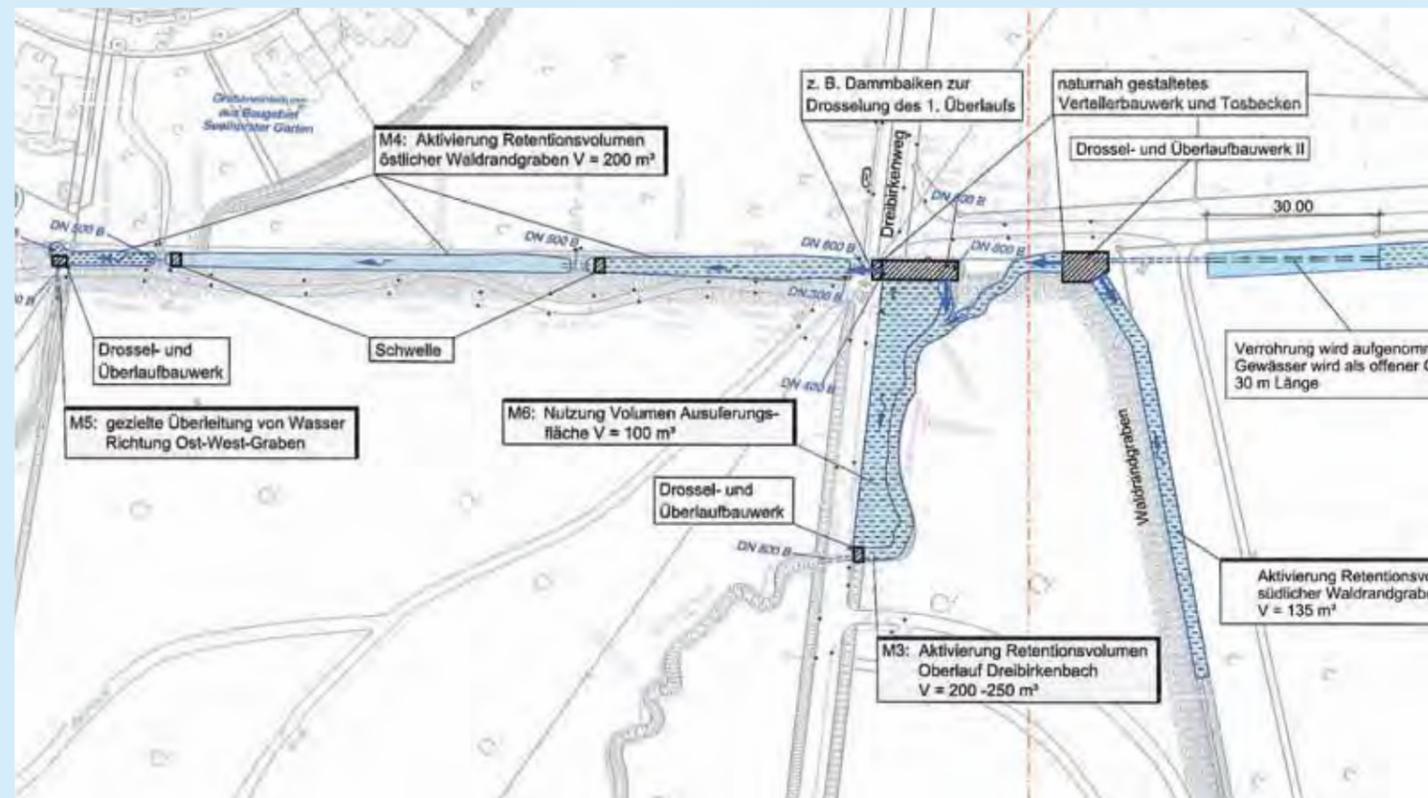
Ausschnitt aus dem Lageplan „Retentionsmaßnahmen Seelhorstwald“ (Plan: Stadtentwässerung Hannover)
